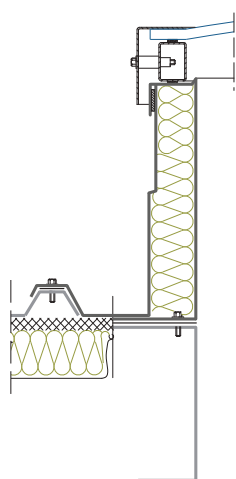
Przekrój poprzeczny przez klapę mcr PROLIGHT typ E z podstawą PR do dachów profilowanych, prostopadle do spadku dachu
